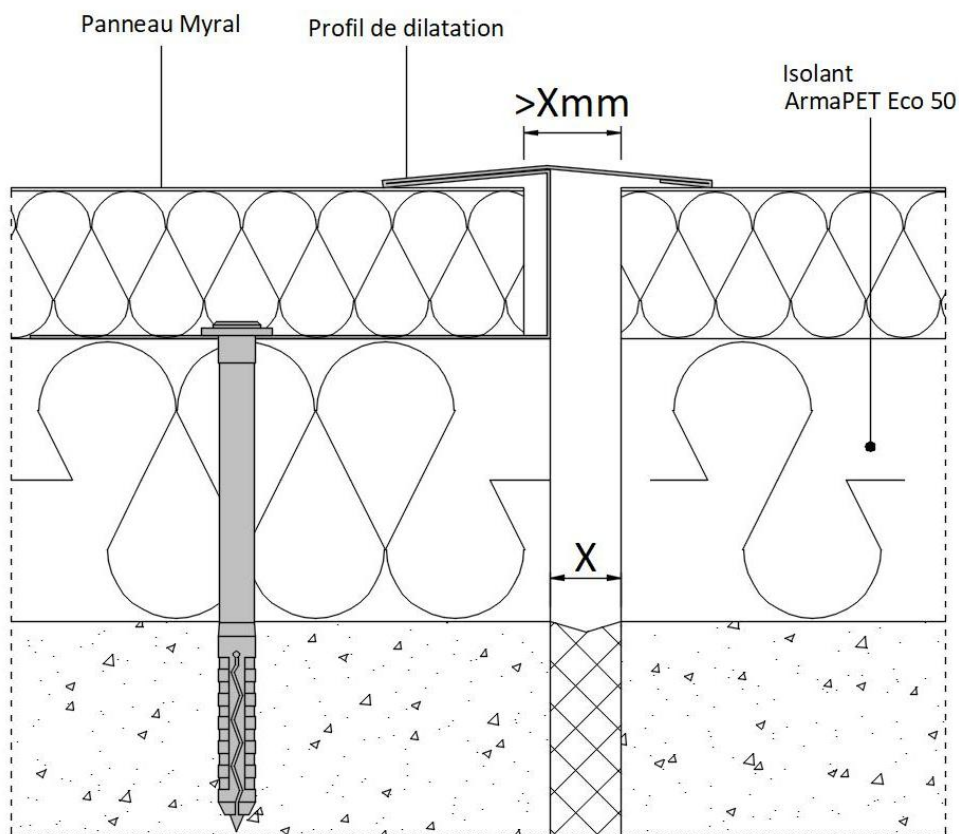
Joint de dilatation du gros œuvre (coupe horizontale)
